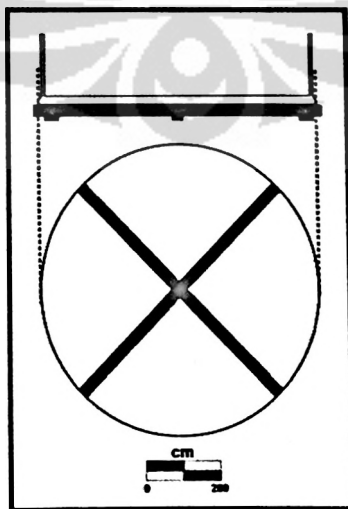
Pipa inlet dan outlet dasar tandonan
